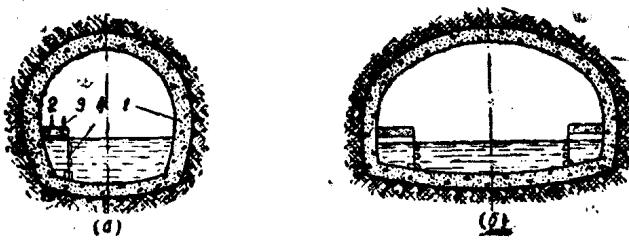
混凝土衬砌的单向 (a) 和双向 (b) 航运隧道截面图
